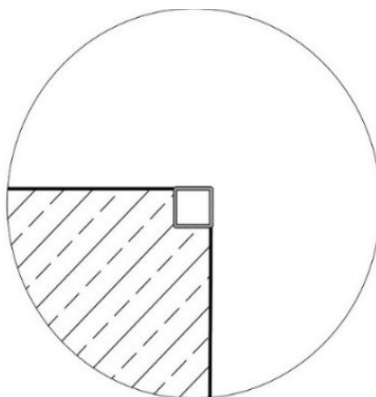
Sposób zabezpieczenia prefabrykatów przed klawiszowaniem
